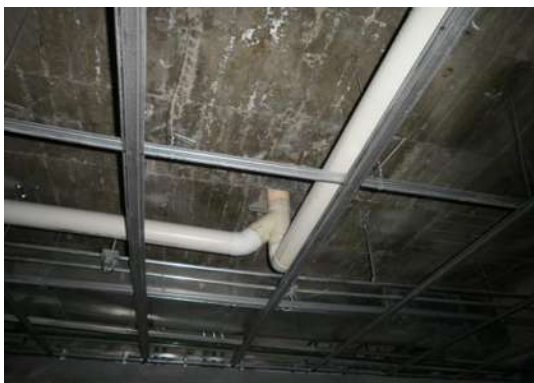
TUBERÍA DE PVC, INJERTADA A LA TUBERÍA DE FIERRO FUNDIDO.
